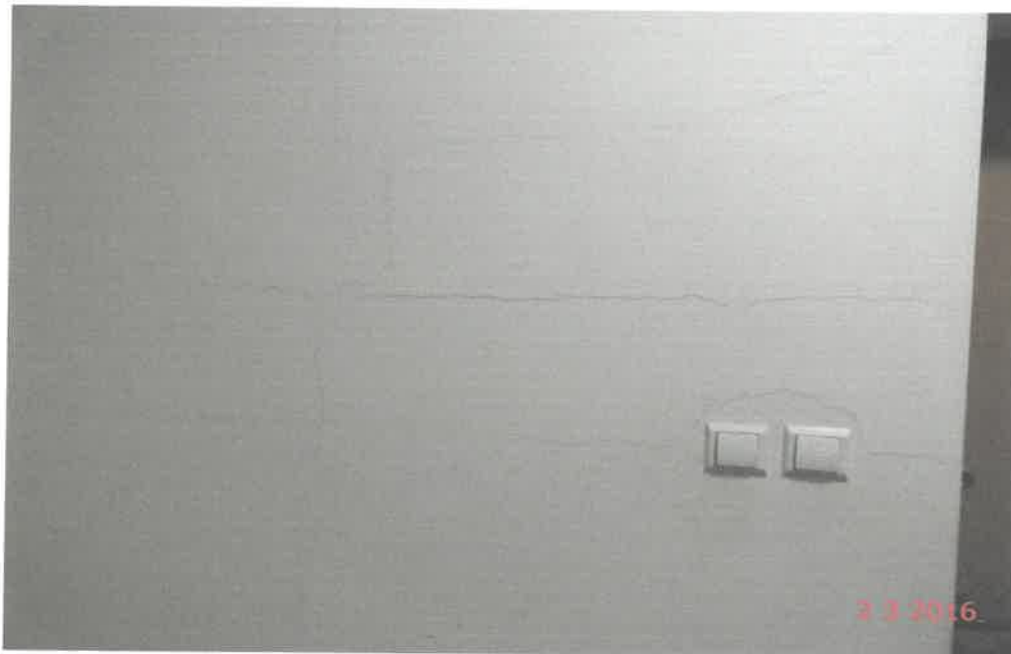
widok tej samej rysy, jaka jest przedstawiona na zdjęciu nr.8 – lecz od strony korytarza.
